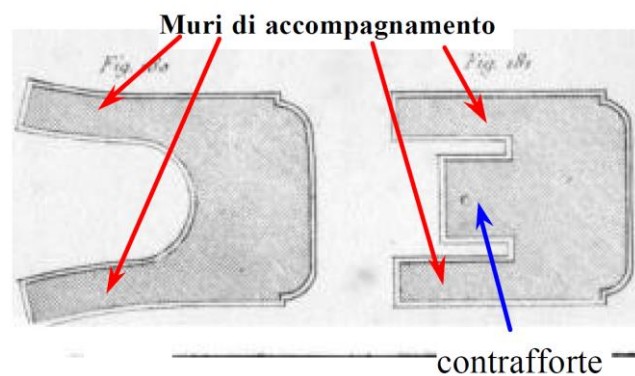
Spalle e muri di accompagnamento delle stesse. [13] [8]
